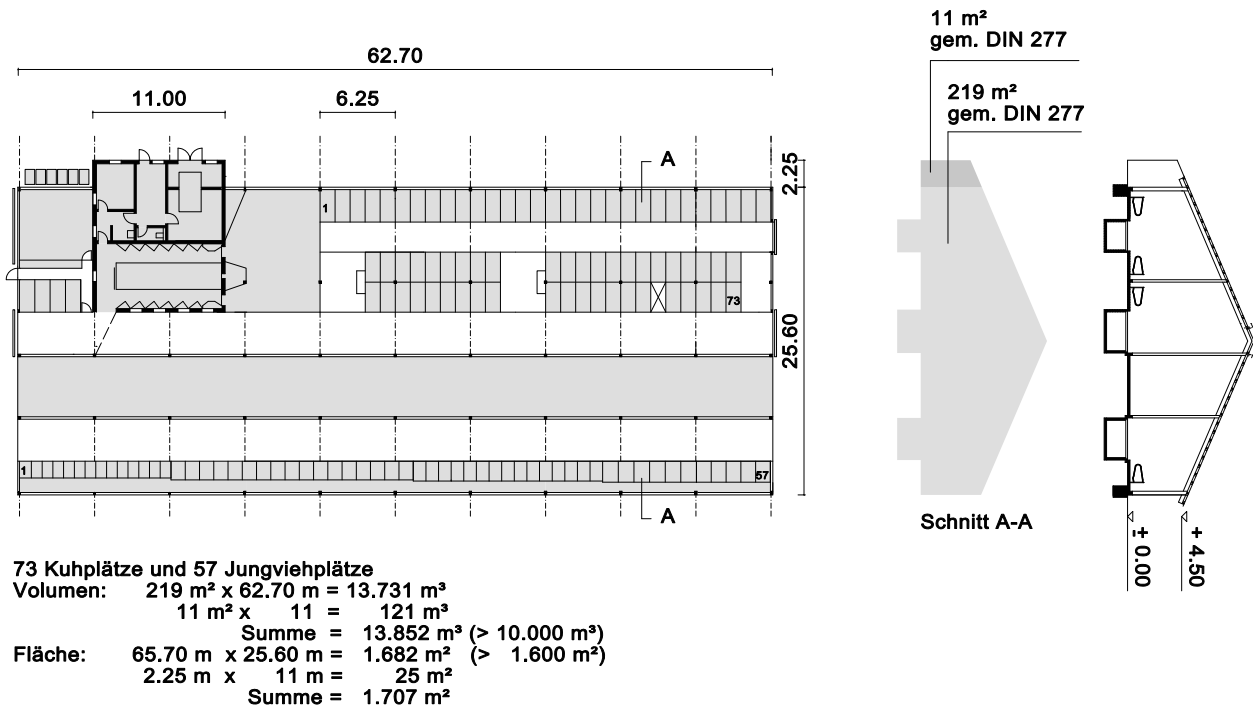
Flächen- und Volumenermittlung für einen Milchviehstall (mit eigener Nachzucht) und integriertem Melkhaus
